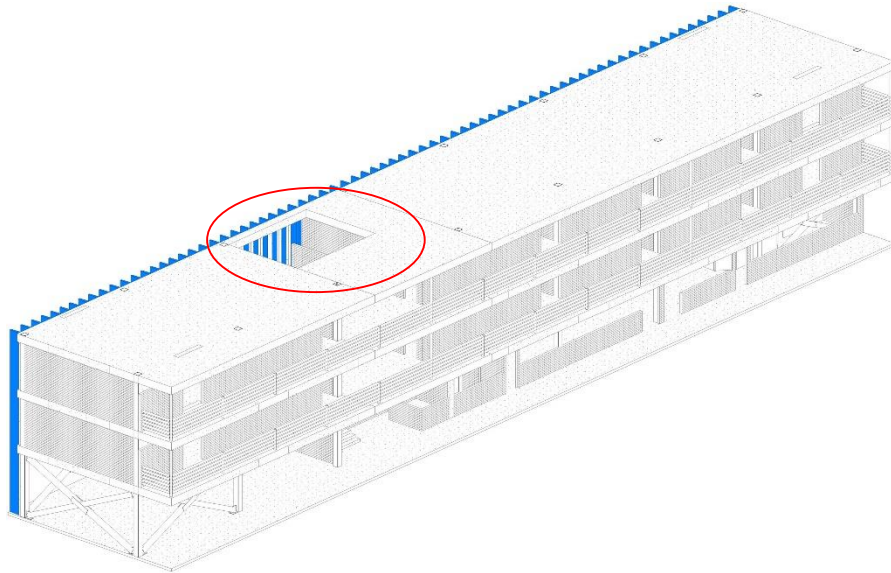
Modelo tridimensional del edificio ING-4, nótese la apertura en la losa de la azotea. Fuente autoría propia, 2023.
